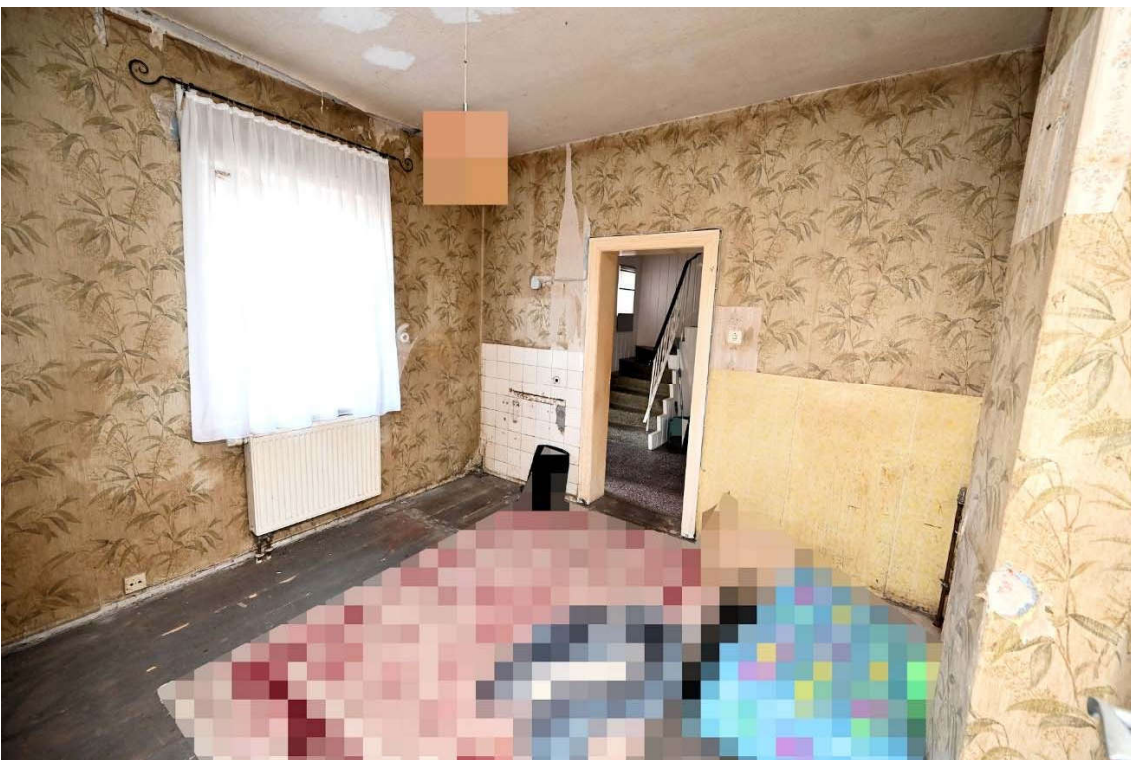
Gebäude A, Erdgeschoss, Zimmer 1
